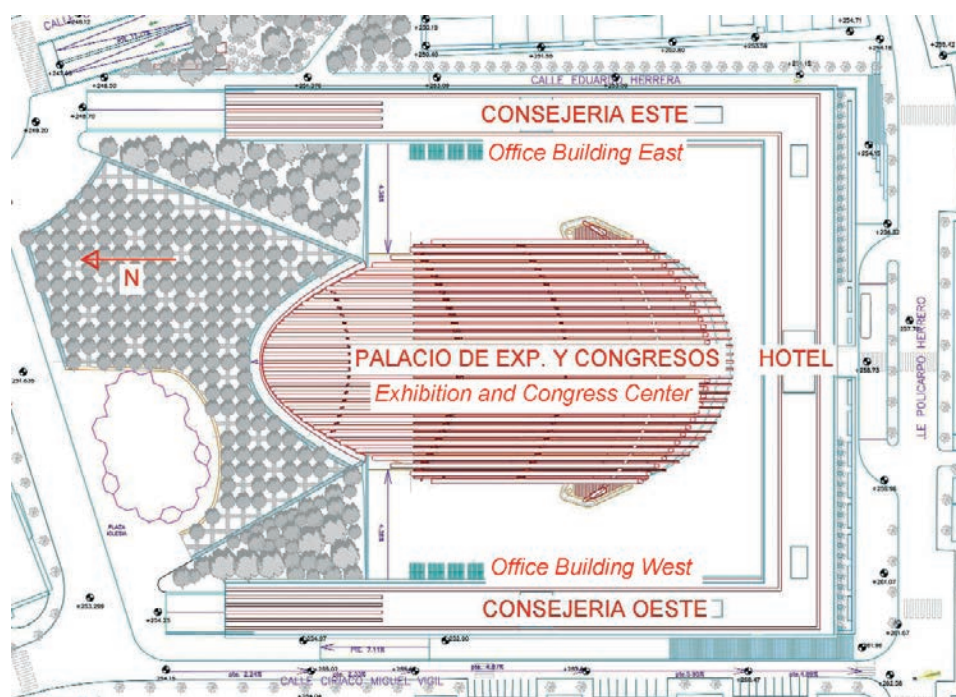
Planta general del conjunto de edificaciones Buenavista
